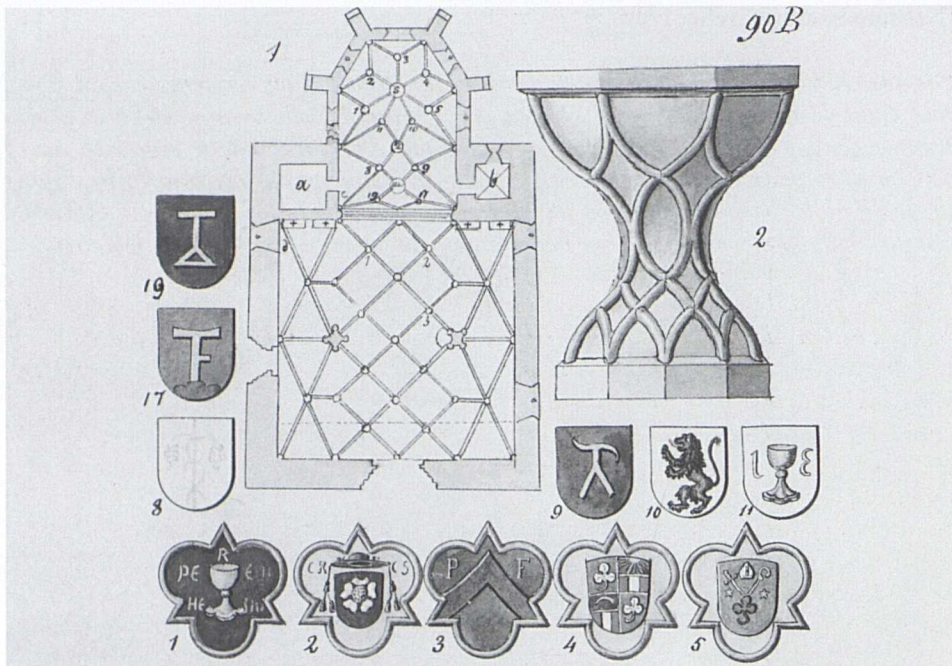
Raron, Kirche, Grundriss und Taufstein / Rarogne, église, plan et fonts baptismaux.
